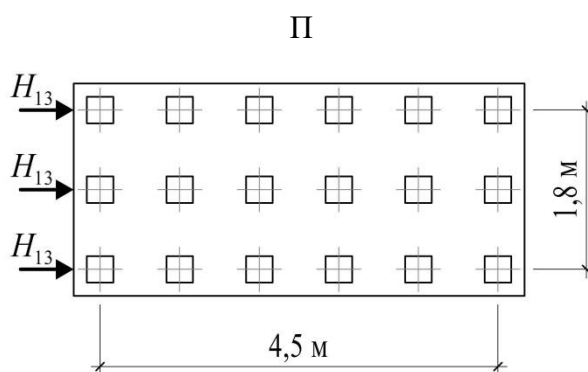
Схема горизонтально нагруженного фундамента из 18 свай
